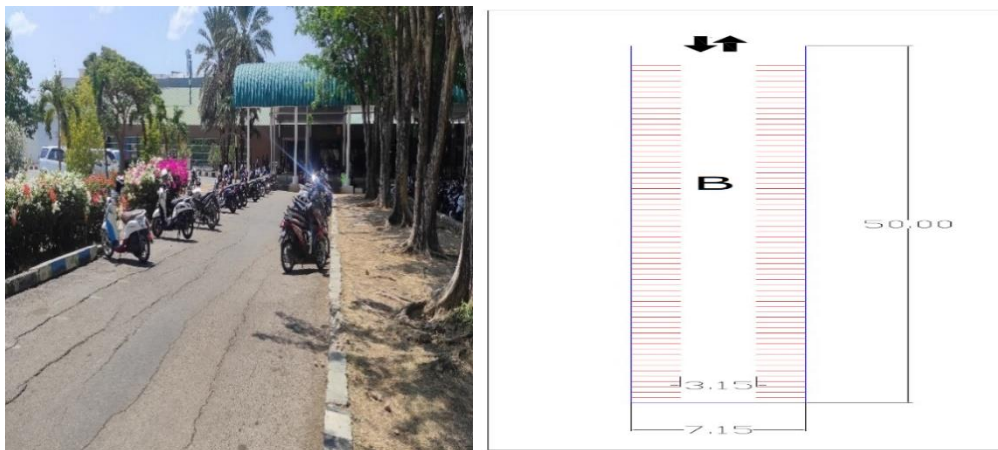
Foto dan Skesa Lahan Parkir A
